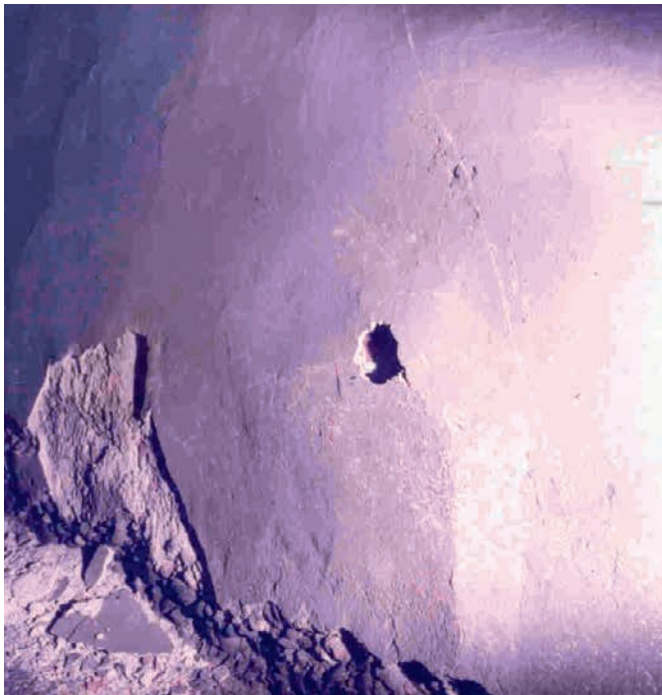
enduit sur béton ancien, fissuré et décollé
